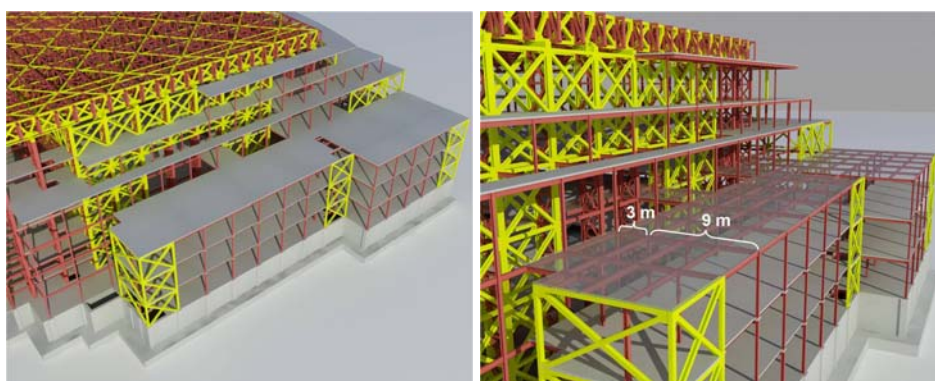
Edificio de Jefes de Estado y fachada Este de entrada al Auditorio.
